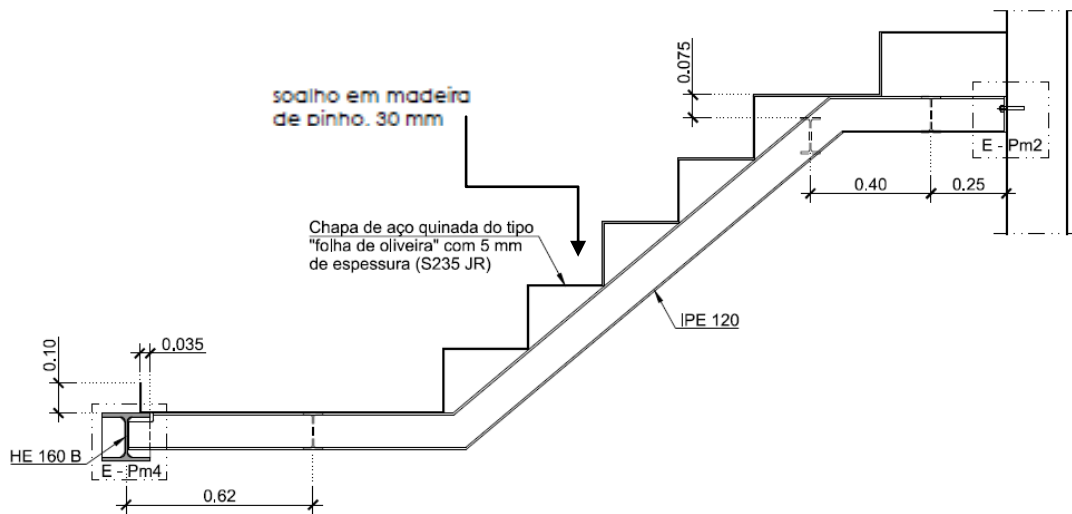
Pormenor construtivo de um dos lanços das escadas [19]
